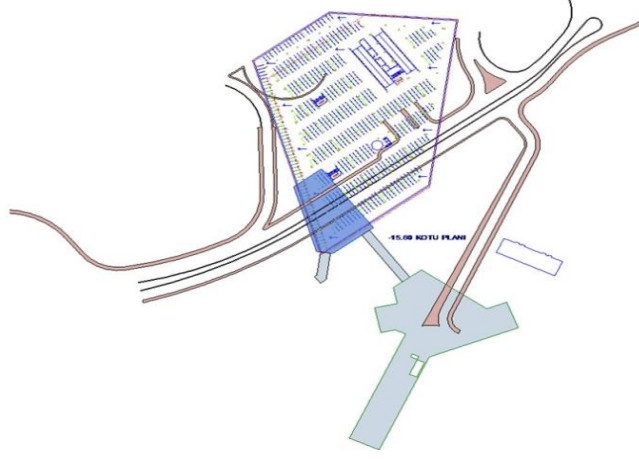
Proje Alanı Planlanan Kesişim Bağlantıları Kesit Görünümü
